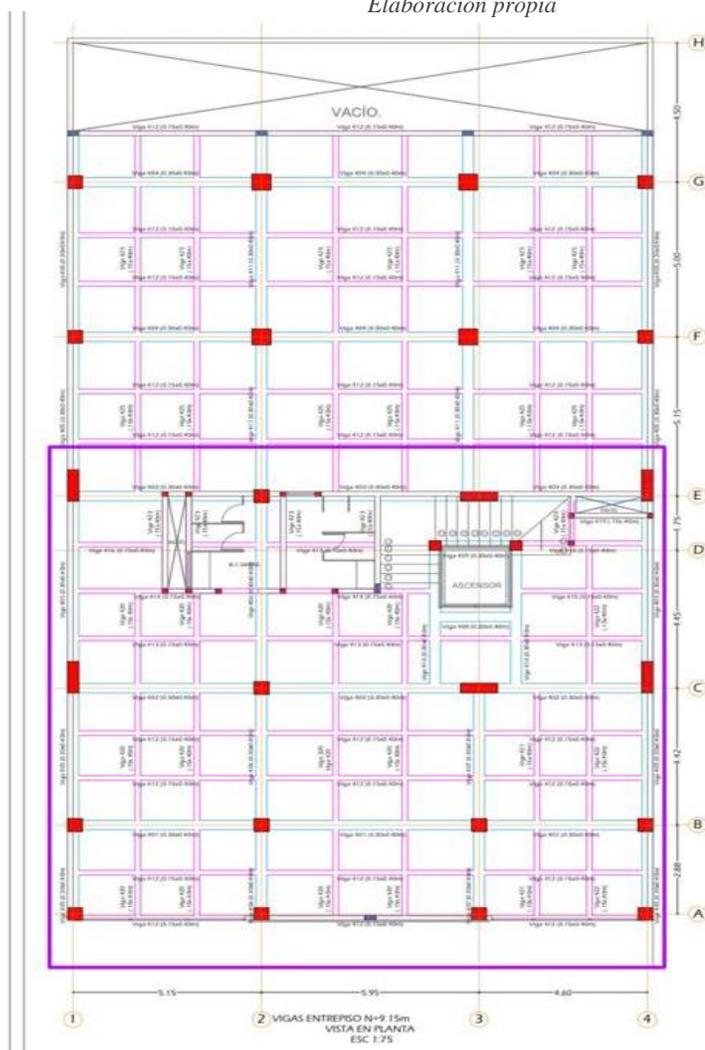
Vista en planta de parte instalada de metaldeck nivel 5
